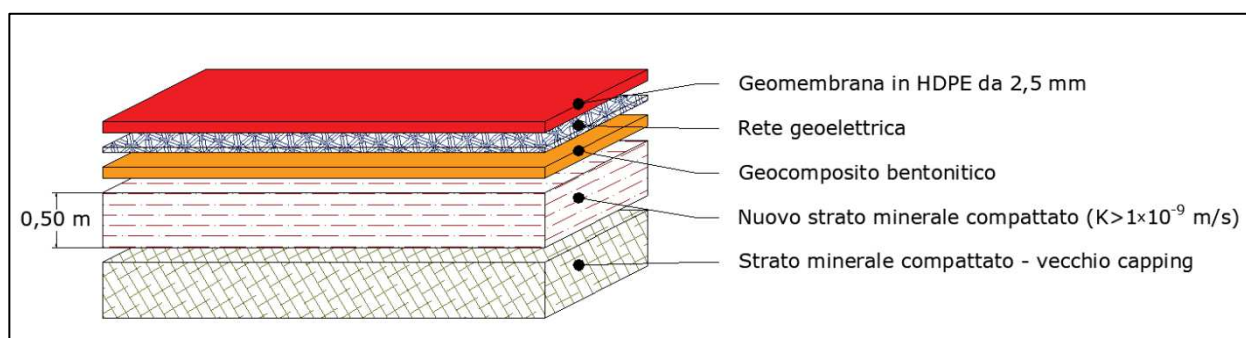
/XVIII: Particolare pacchetto impermeabilizzazione area abbancamento
